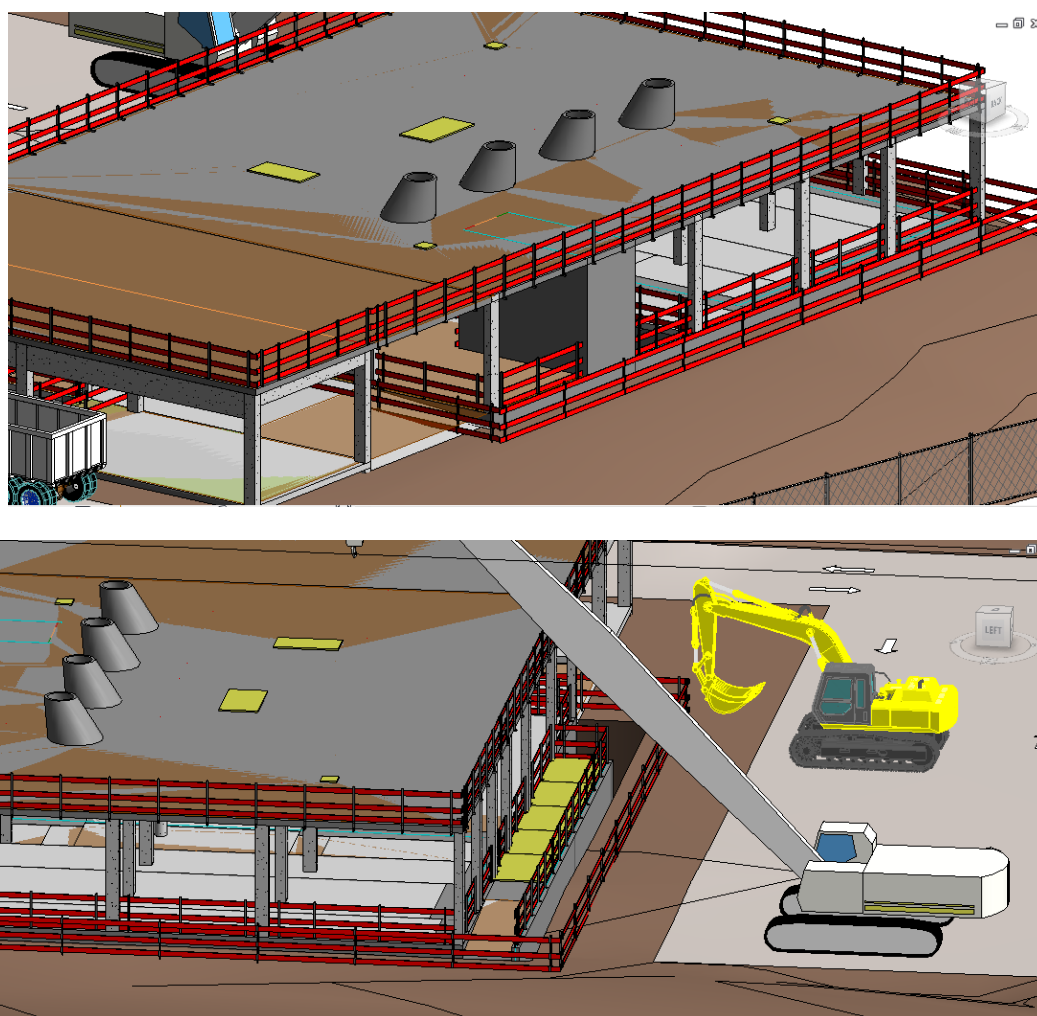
Vistas pormenorizadas dos elementos de segurança no modelo estrutural
